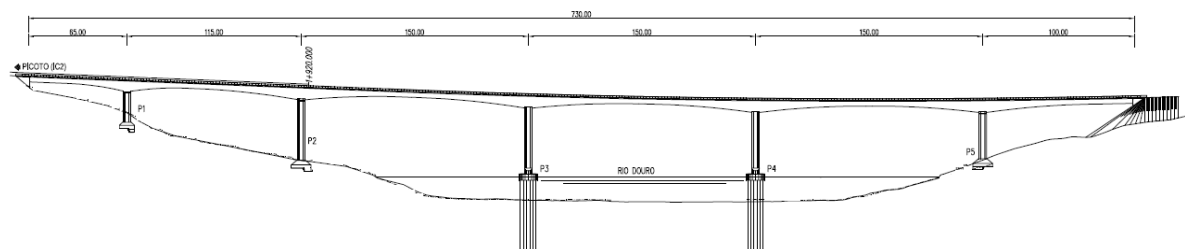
Alcançado da Ponte sobre o Rio Douro, pormenor das fundações.
